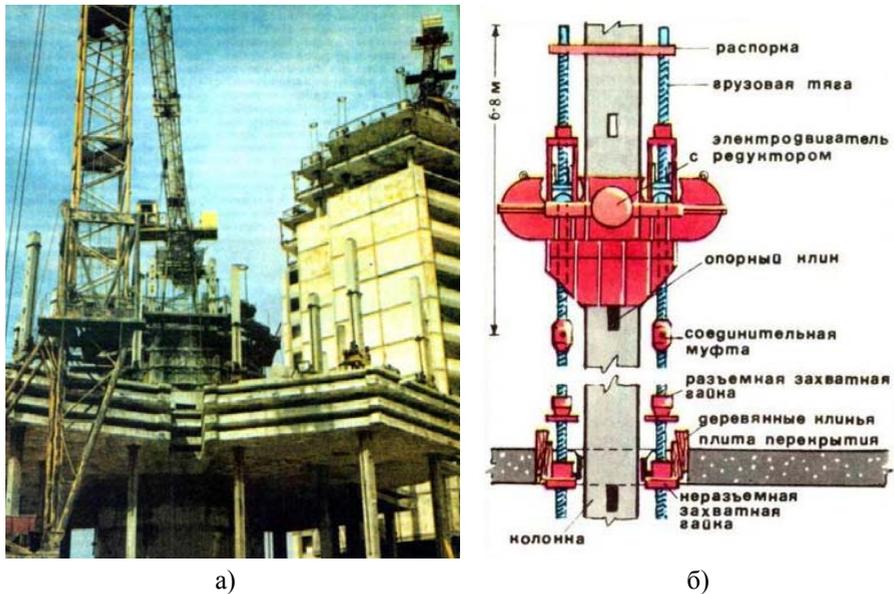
Общий вид возведения здания методом подъема перекрытий (а)
